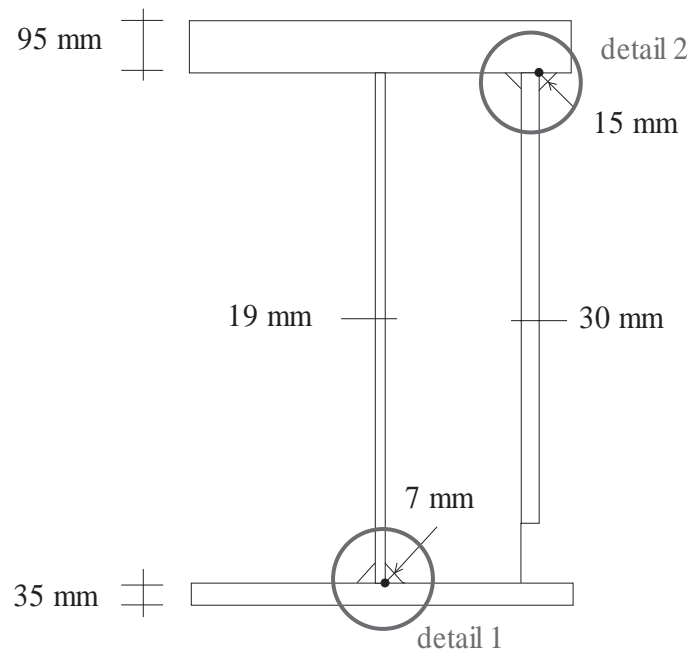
Deux détails de soudage pour un pont bipoutre. Dimensions en (mm)
